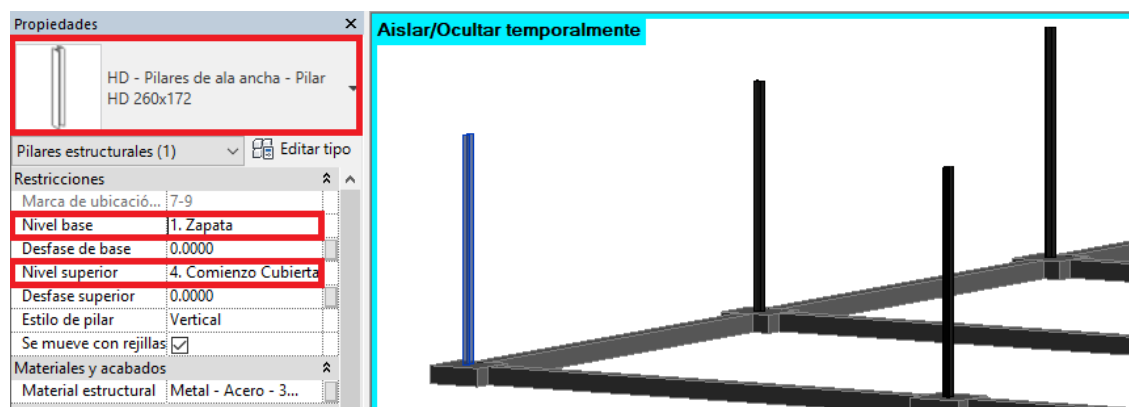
| COLOCACIÓN DE PILAR DE ACERO CON RESTRICCIONES | Fuente propia
